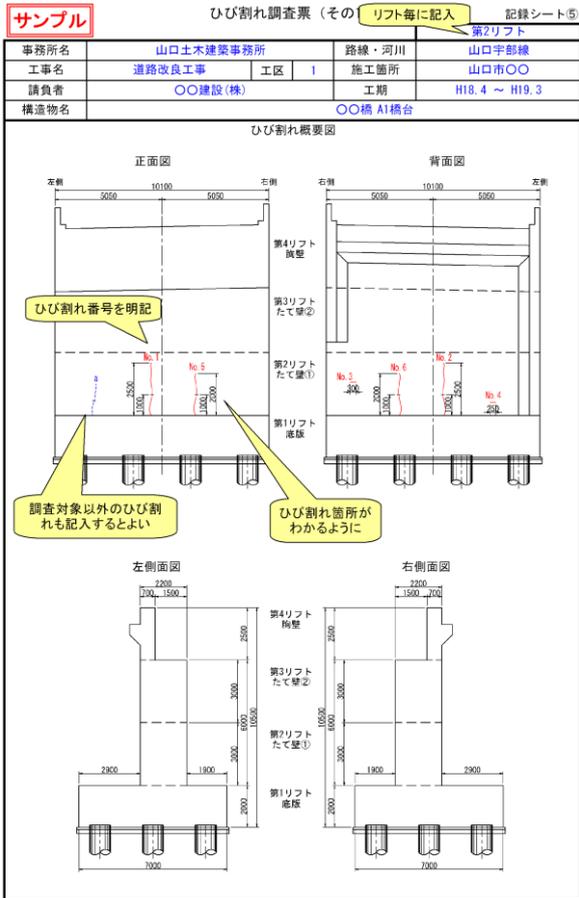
コンクリート打設管理記録 (ひび割れ調査票 1)
